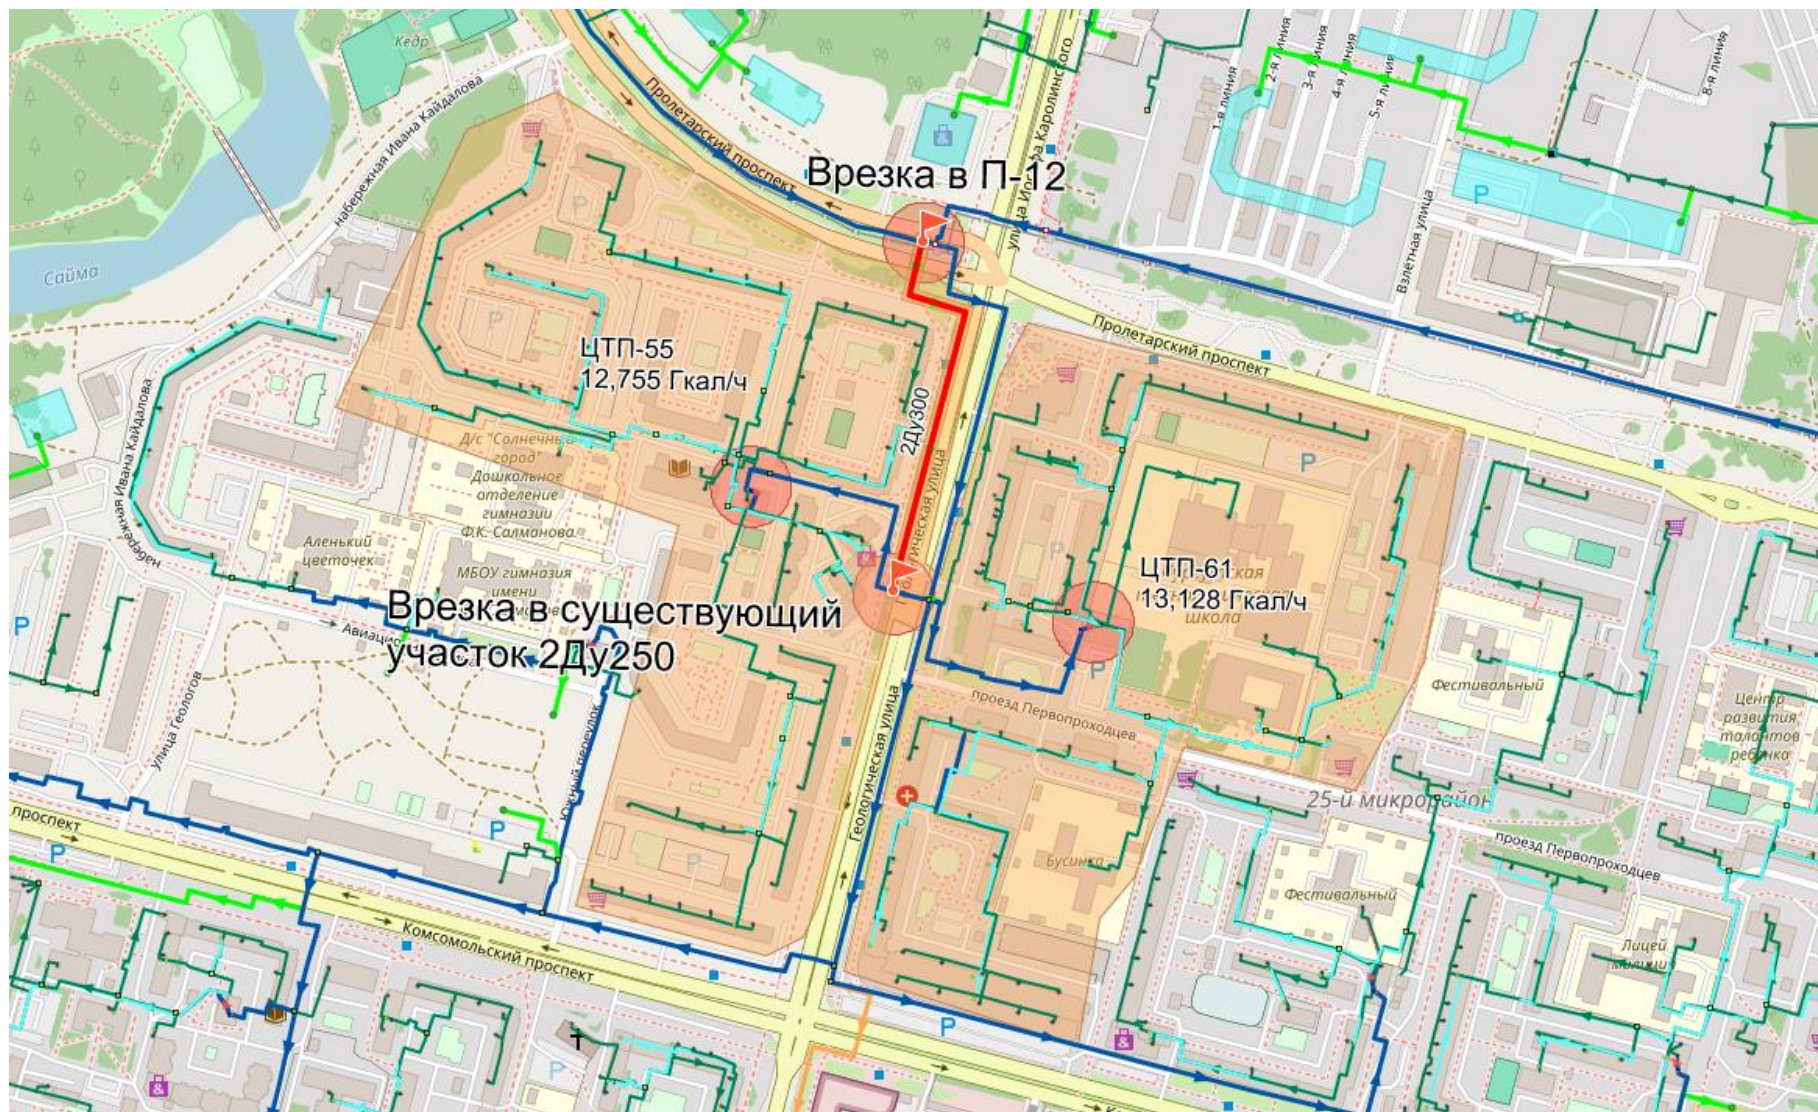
Схема расположения планируемой перемычки 2Ду300 и переключаемых зон теплоснабжения ЦТП-55, ЦТП-61 от СГРЭС-2 на СГРЭС-1 – ПВК
